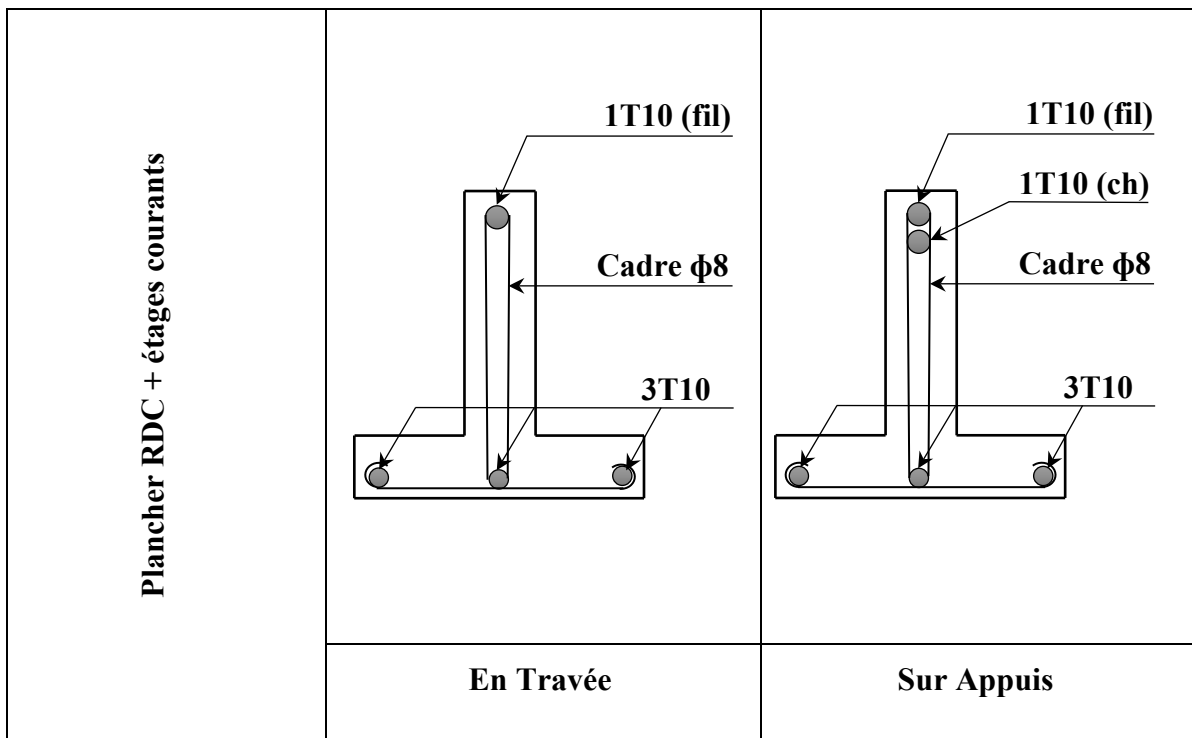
Dessin de ferrailage des poutrelles des étages courants et RDC
